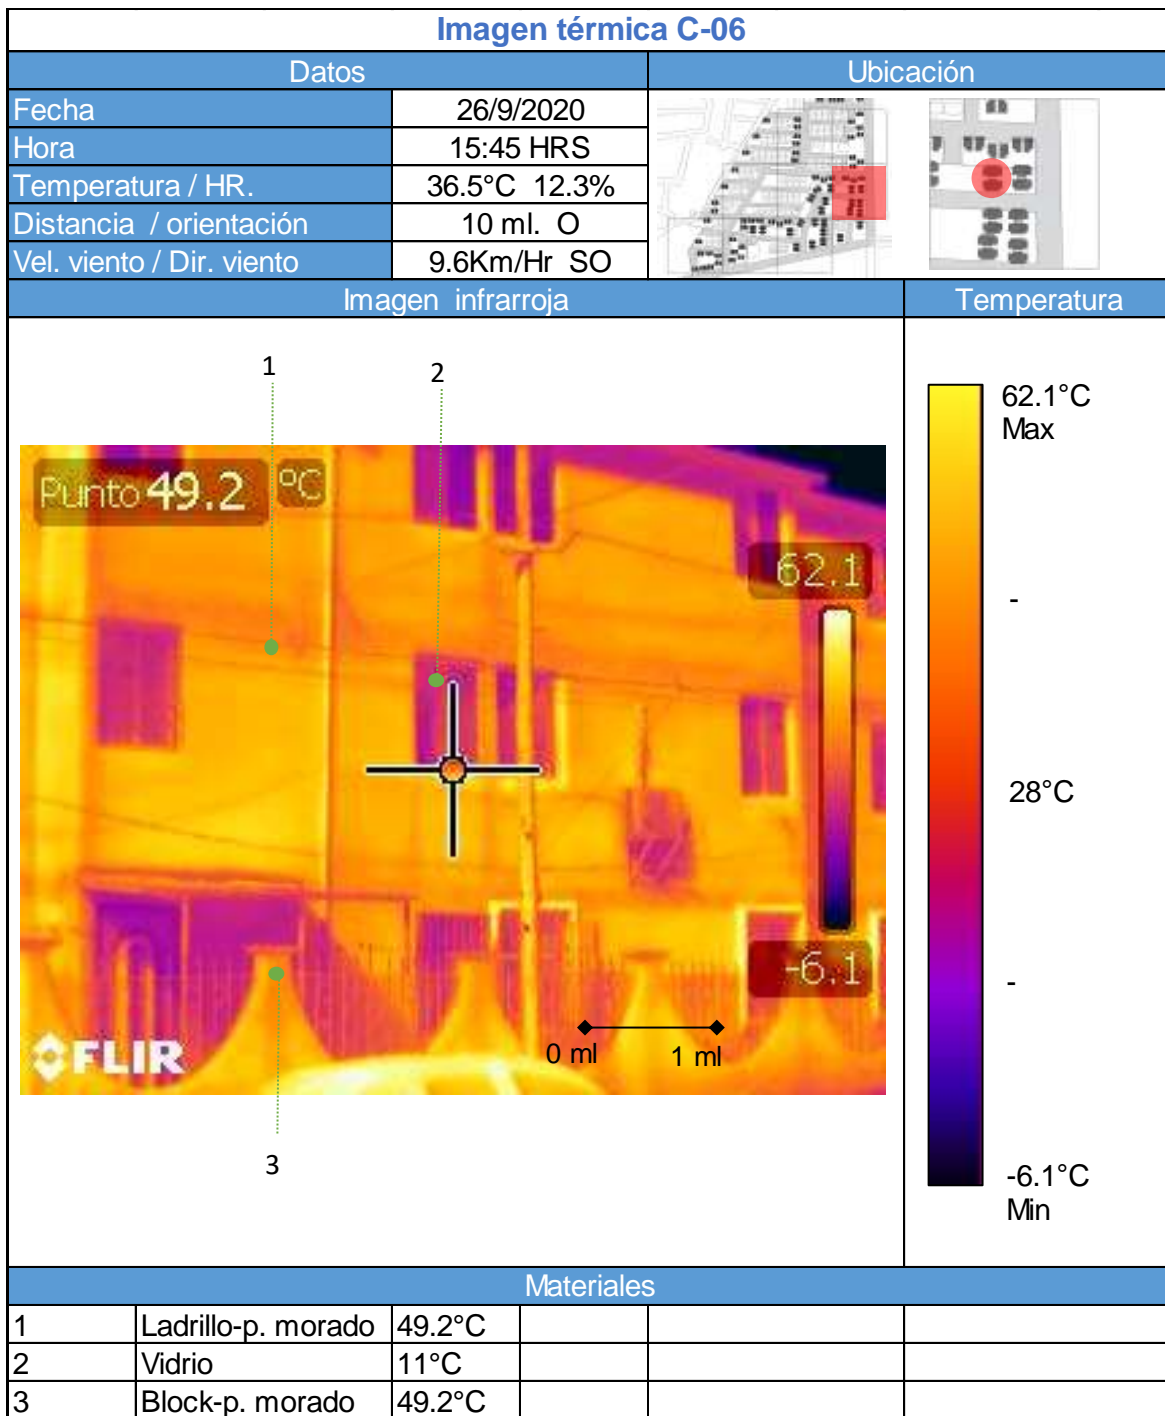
Ficha de imagen térmica C-06, con fachada al Sur.
